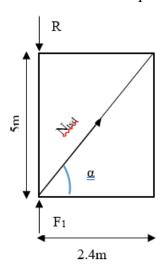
Schéma statique d'une partie de la poutre au vent de pignon avant
